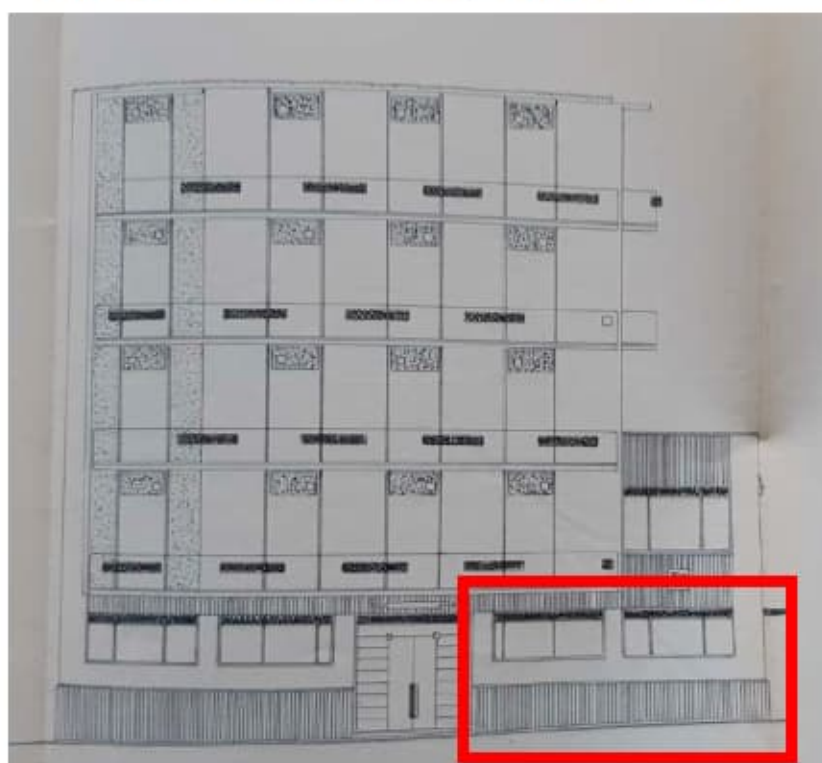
Prospetto lato Via Filippini - Stato autorizzato
